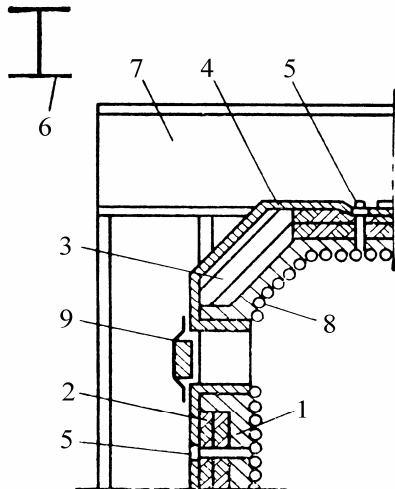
Угол топочной камеры с натрубной обмуровкой (горизонтальный разрез): 1 – огнеупорный бетон; 2 – совелит; 3 – термоизоляционный бетон; 4 – уплотнительная обмазка; 5 – стяжной болт; 6 – колонна каркаса; 7 – балка пояса жесткости; 8 – экранная труба; 9 – смотровой лючок
